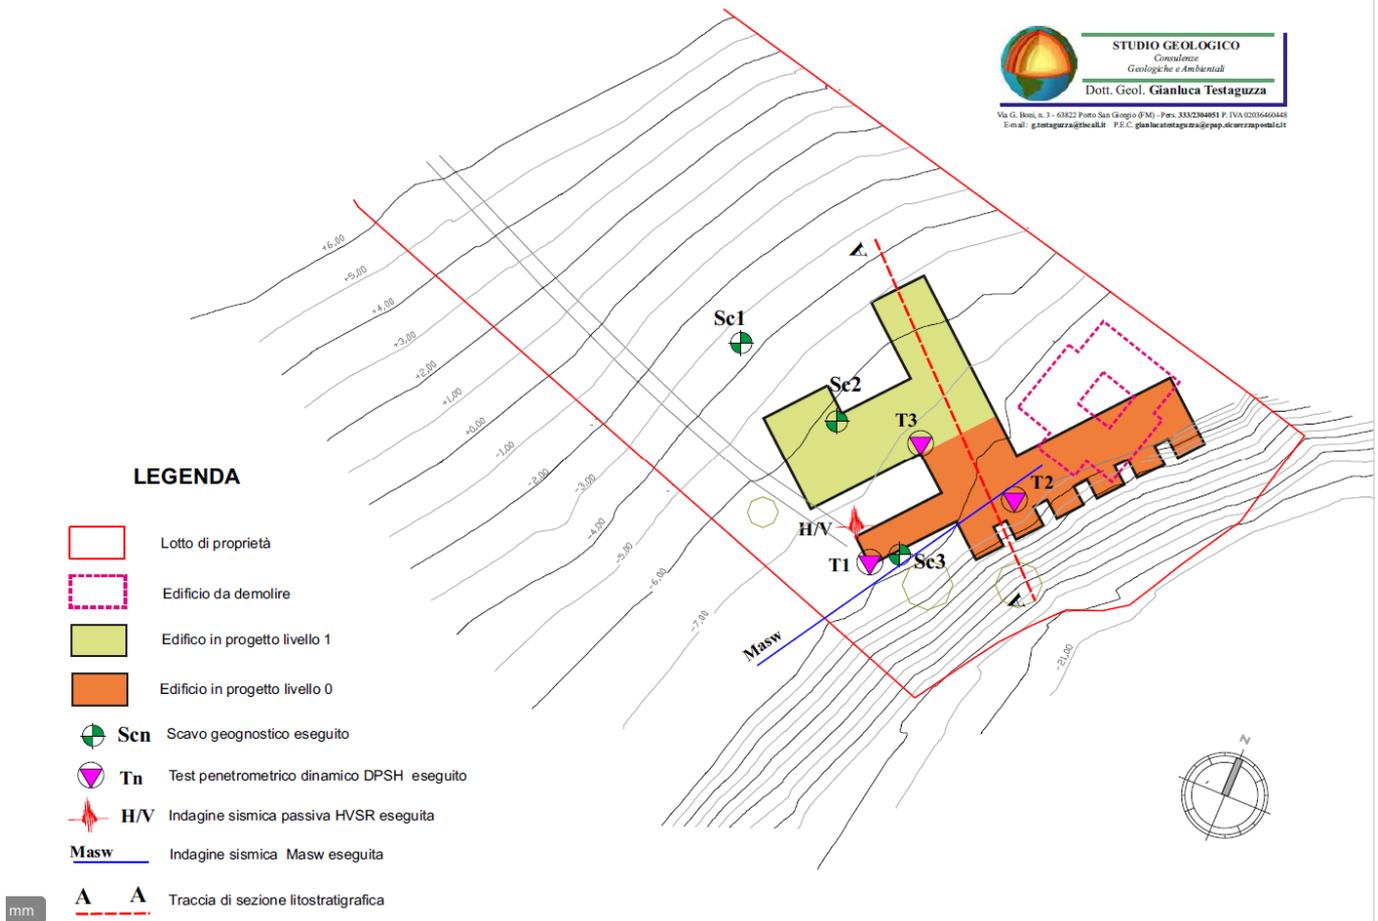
e 9: immagini tratte dal Rapporto Geologico-Sismico riportante rispettivamente una sezione dell'edificio in progetto e la pianta dell'edificio in progetto con il perimetro di quello da demolire. Dalle immagini si ha idea dell'entità delle trasformazioni previste, che interesserebbero una superficie molto più ampia dell'area di sedime e della corte dell'edificio attualmente presente, andando ad interessare anche la scarpata e quindi la formazione vegetale ivi presente.
